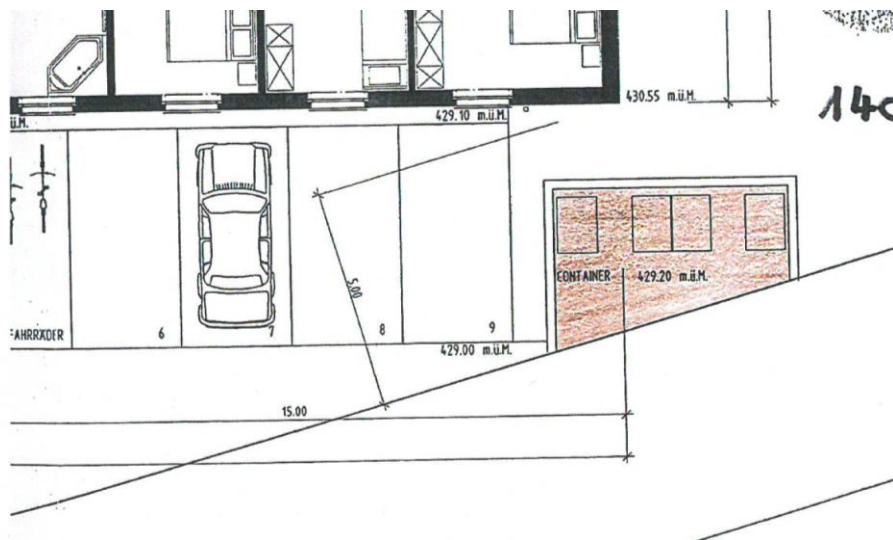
Ausschnitt: Plan des Containerplatzes Parzelle Nr. 1404 (Dienstbarkeit 1706.4806)
